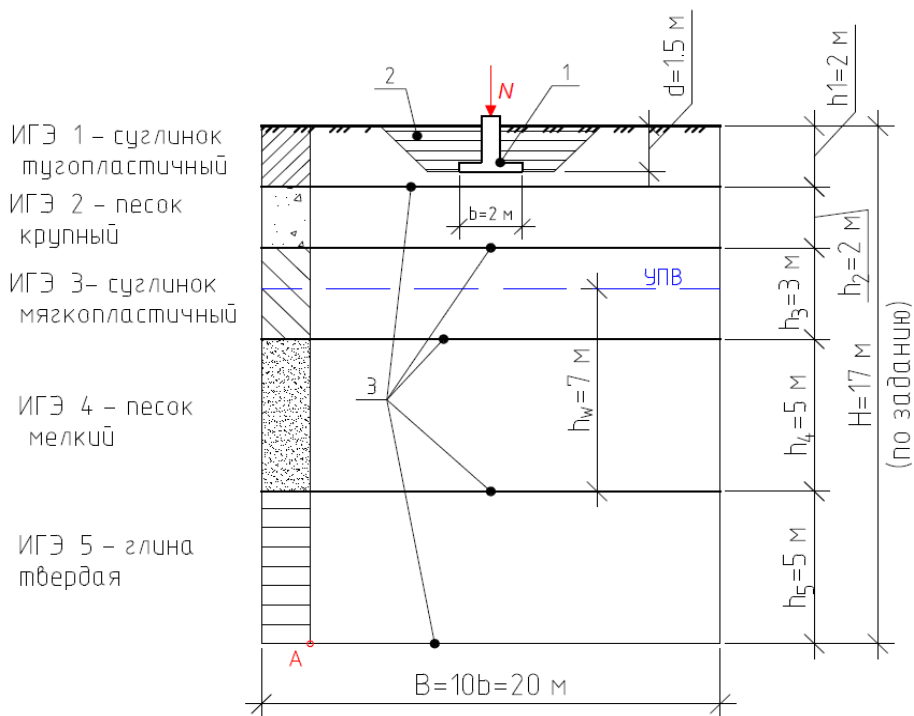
Модель посадки ленточного фундамента здания на грунты основания: 1 - ленточный фундамент; 2 – грунт обратной засыпки пазух фундамента; 3 – границы инженерно-геологических элементов (ИГЭ-1...ИГЭ-5); УПВ – уровень подземных вод; b – ширина подошвы ленточного фундамента; d – глубина заложения фундамента; B – ширина модели посадки ленточного фундамента ($B = 10b$)
